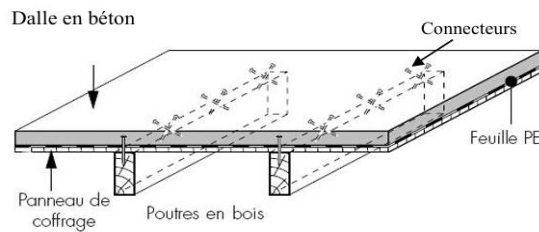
2: Schéma de principe d'un plancher mixte en bois-béton. [6]
